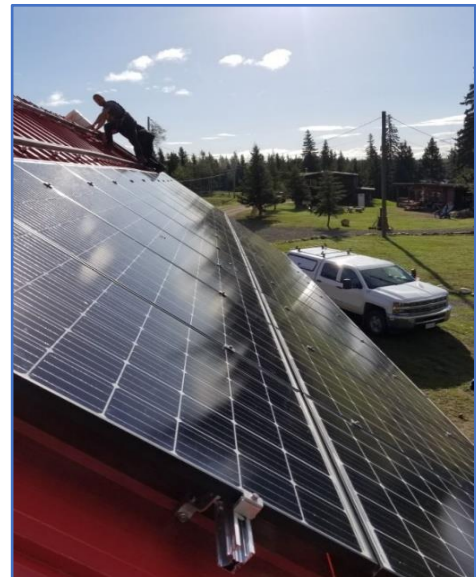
Fixations de rampes à un toit en métal à joint debout – avec l'aimable autorisation de Riverside Energy Systems
